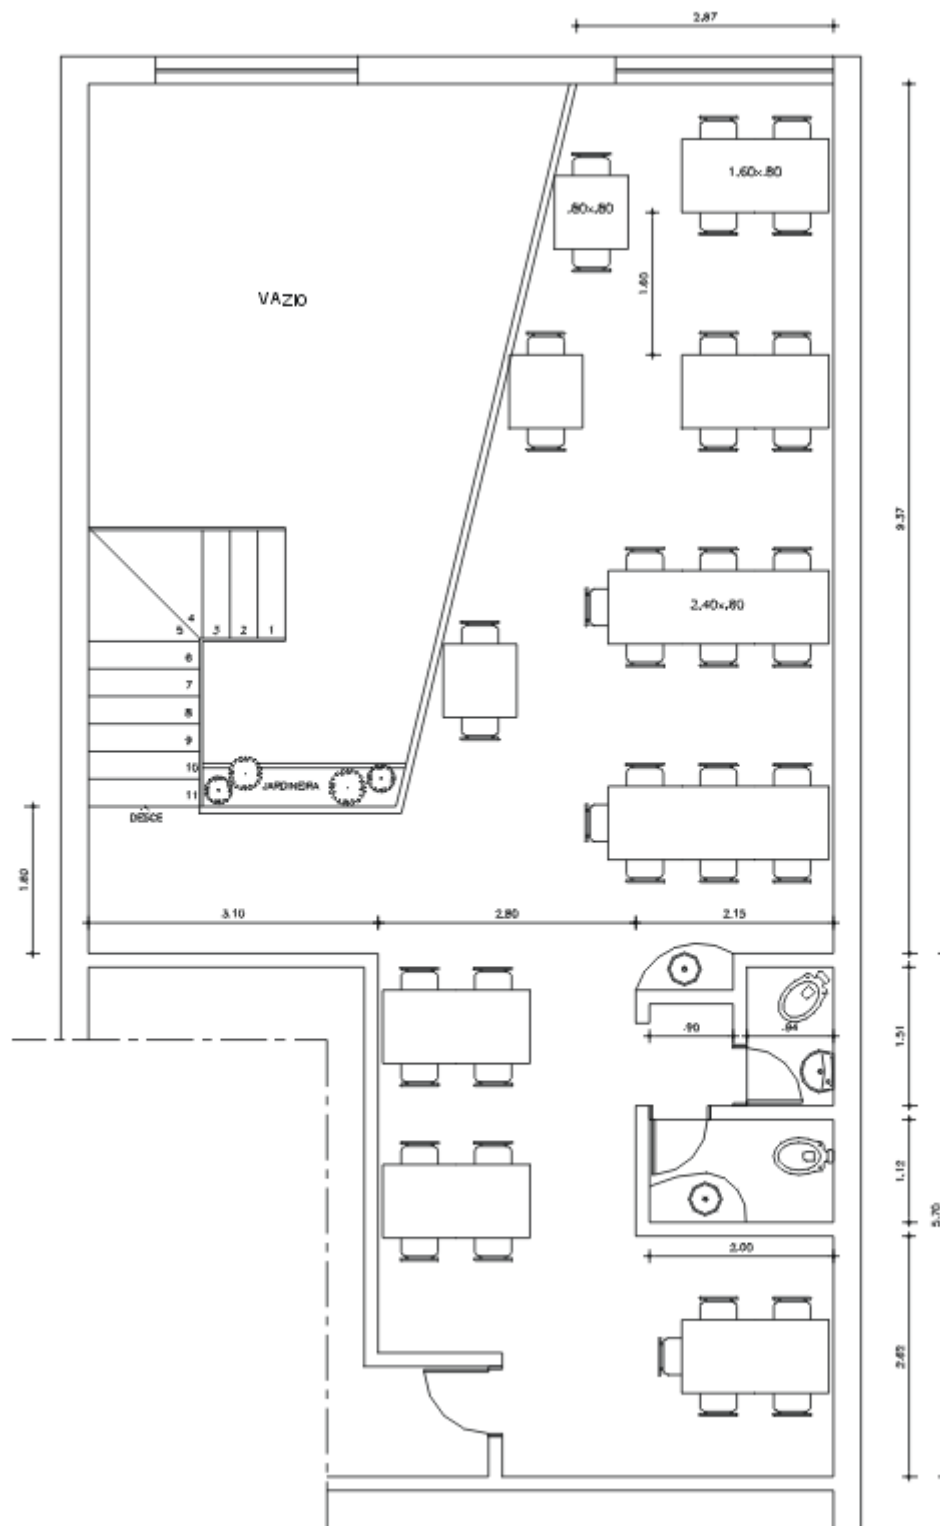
Planta baixa (lay-out) do mezanino do restaurante “B”.
